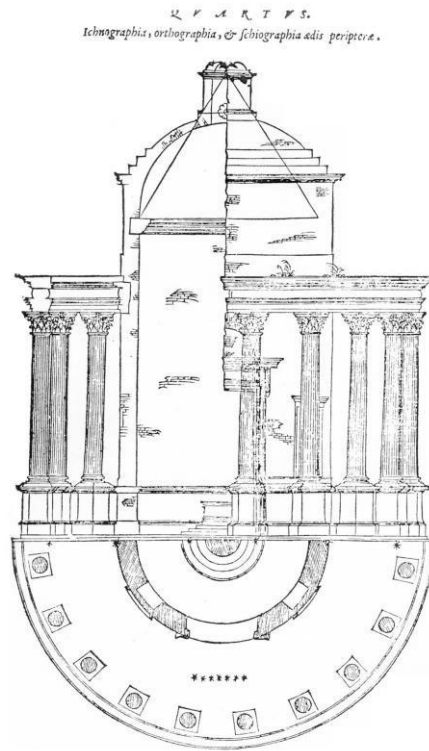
Planta, corte y alzado en un mismo dibujo por Palladio.
